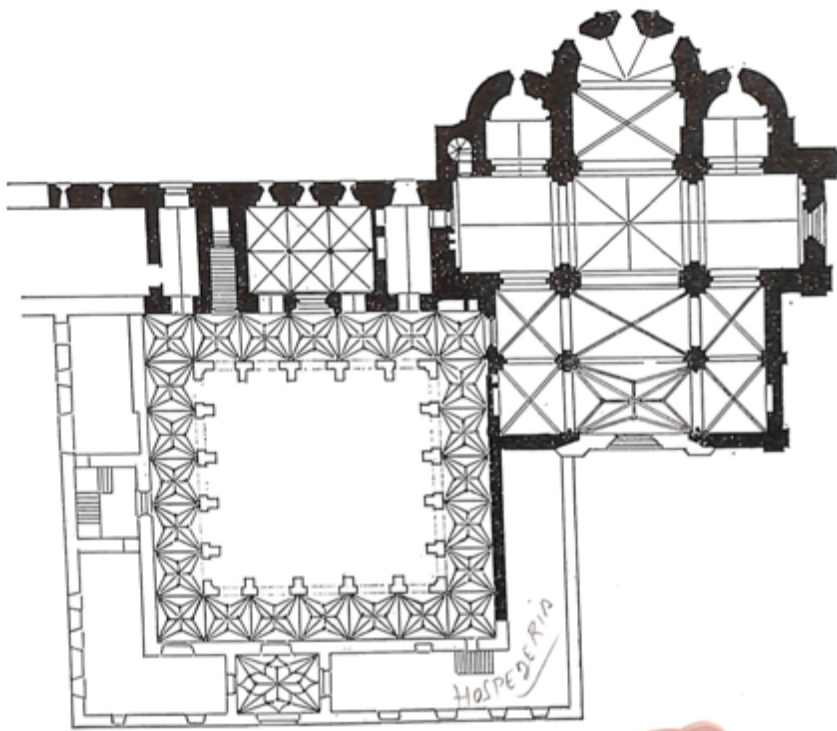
Monsalud, Santa María, Grundriss Kirche und Kloster, Pérez Arribas (nach Torres Balbás), 1978.
